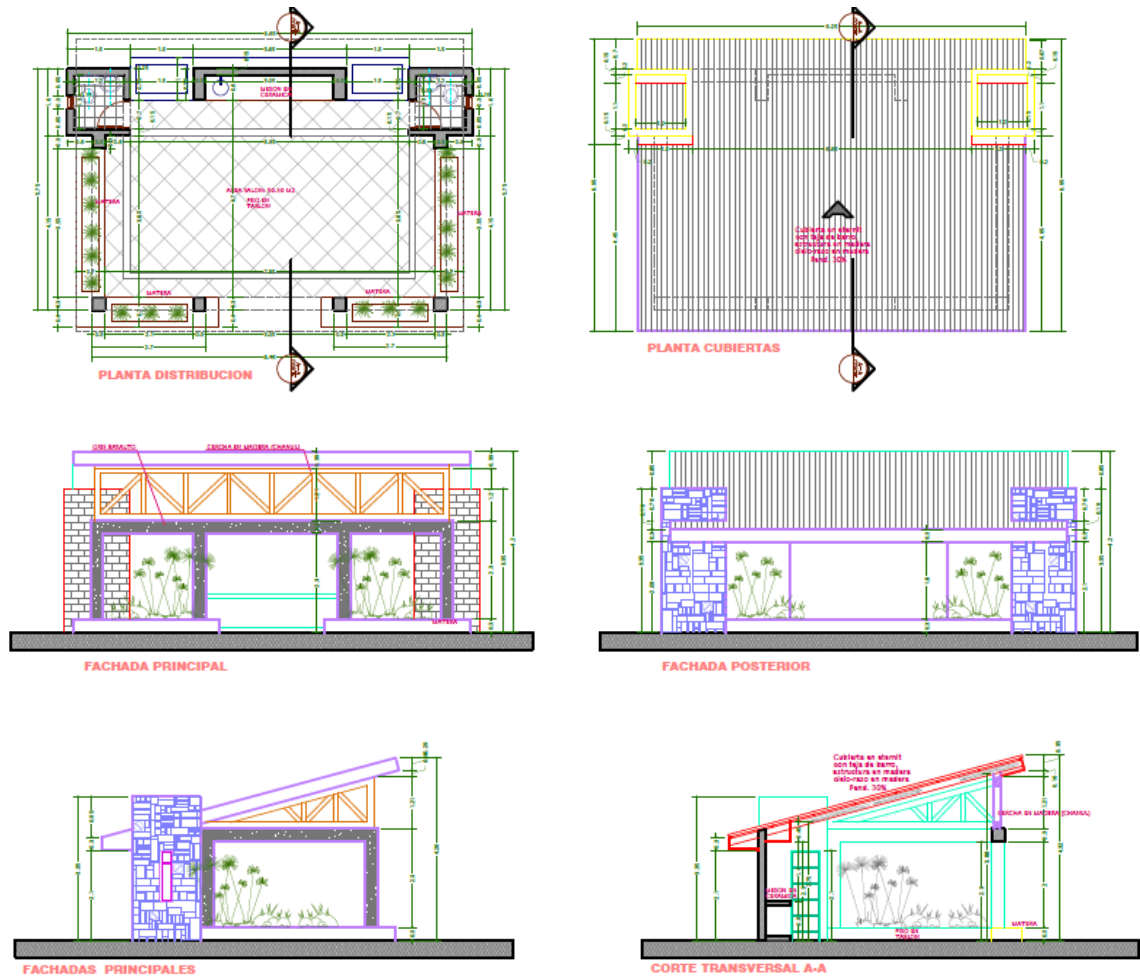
Planos del diseño arquitectónico del Salón Común
